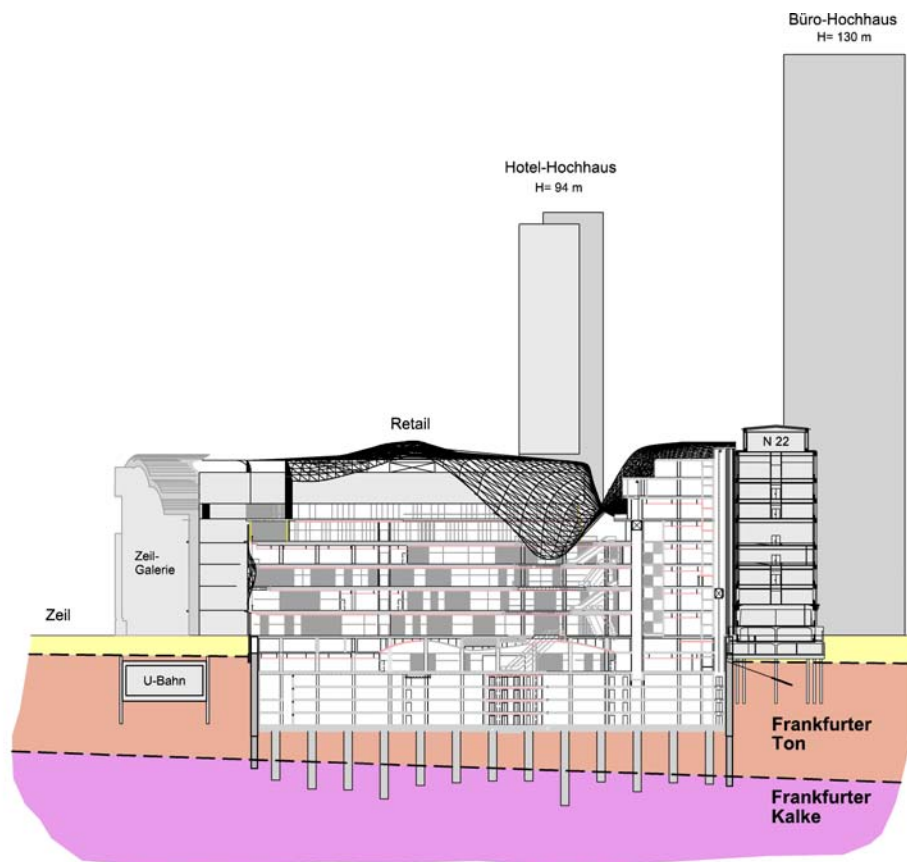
Baugrund- und Projektschnitt FrankfurtHochVier
